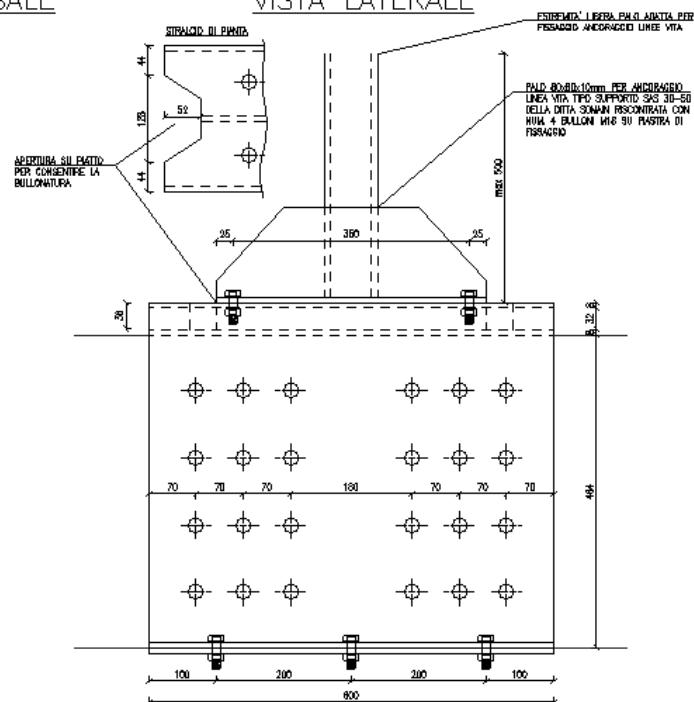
Ancoraggio tipo su strutture in legno lamellare
